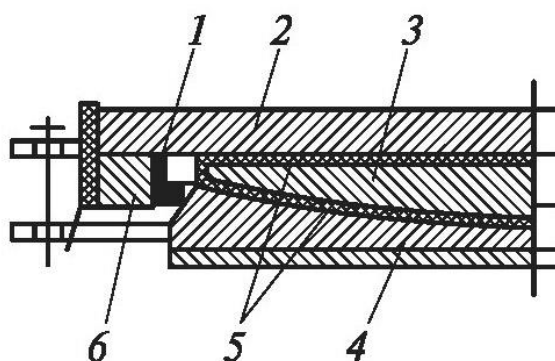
Конструкция шаровой сферической линейно-подвижной опорной части (ШСОЧ - ЛП): 1 - пара трения; 2 - скользящая плита; 3 - верхний балансир (шаровой сегмент); 4 - нижний балансир; 5 - фторопластовый диск, ушки для транспортировки; 6 - направляющая
